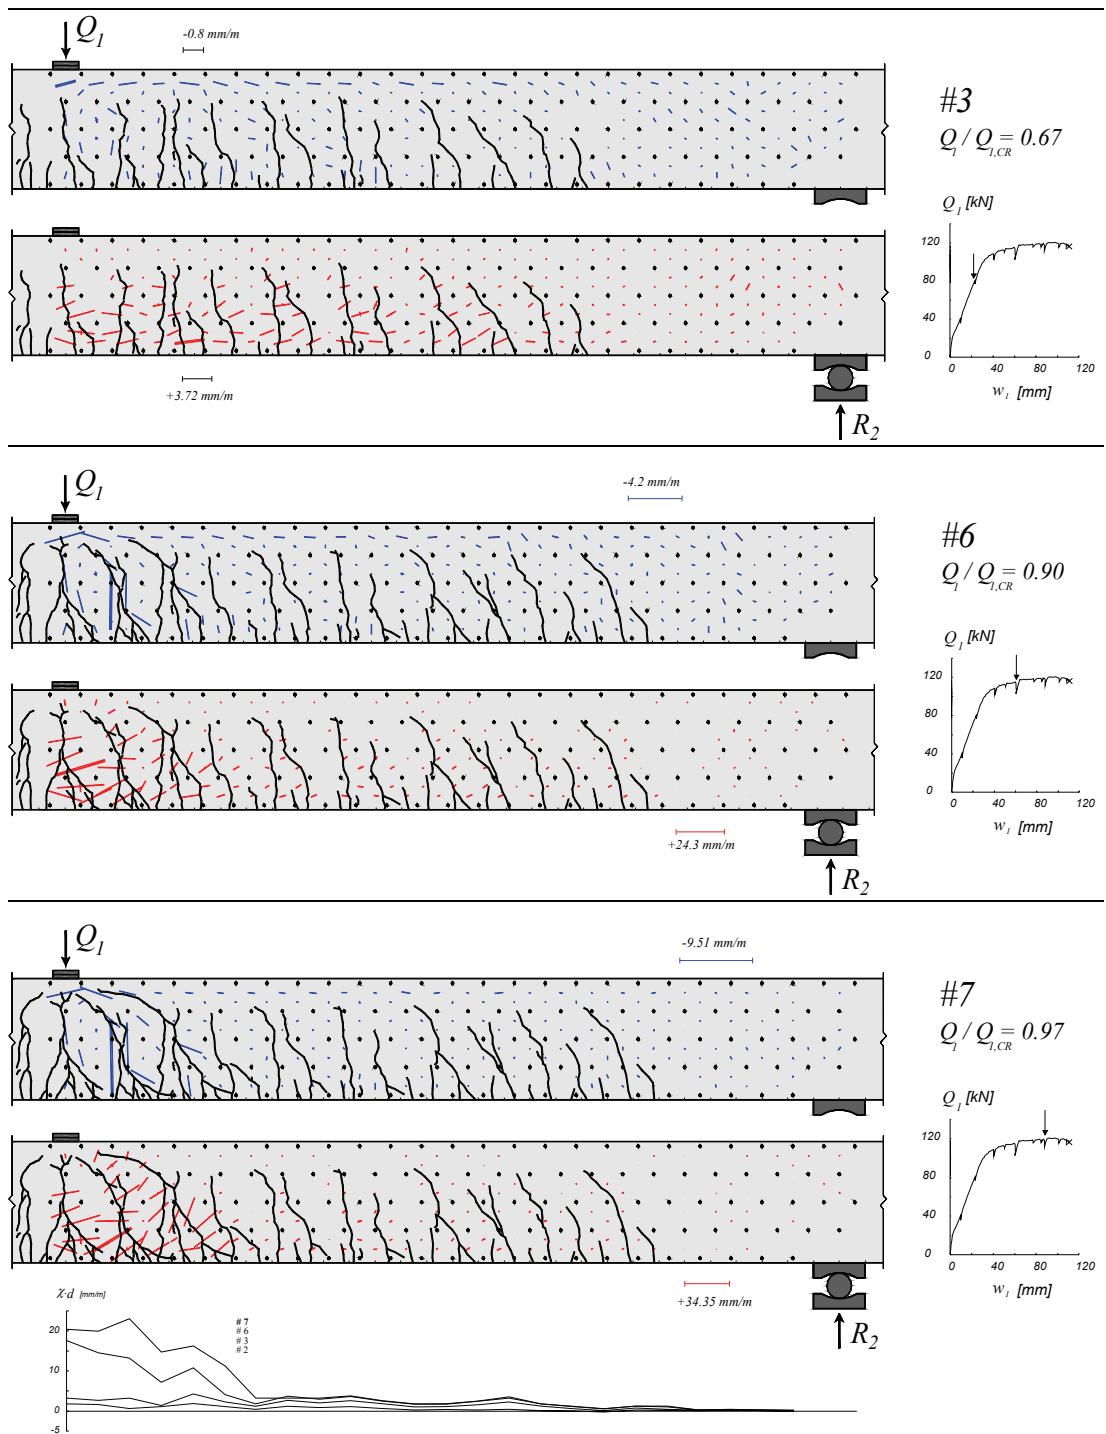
Poutre SR4: déformations principales, fissuration et courbures
